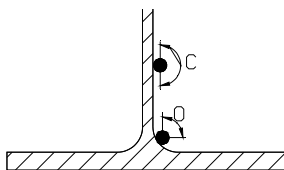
Perimetro efficace delle barre di armatura.
